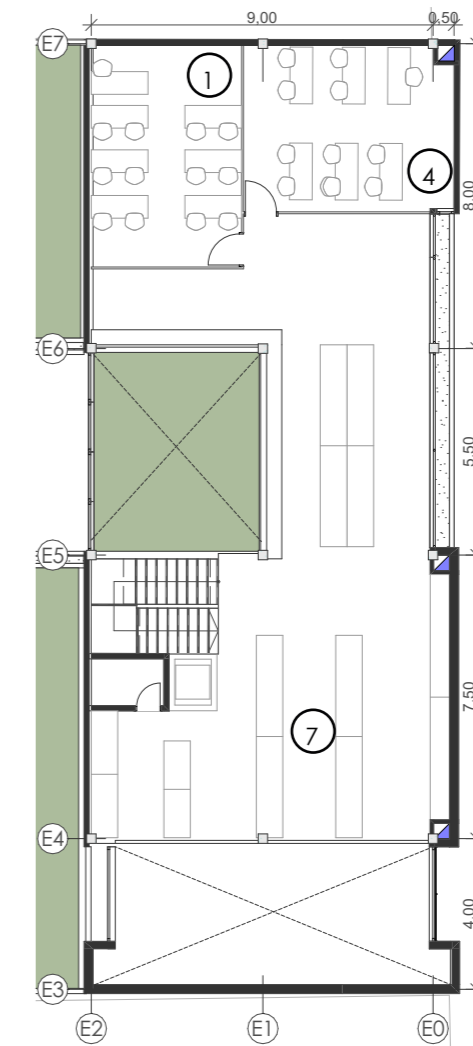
Primera Planta Alta de la Biblioteca Elaboración propia (2026). Escala 1:200
